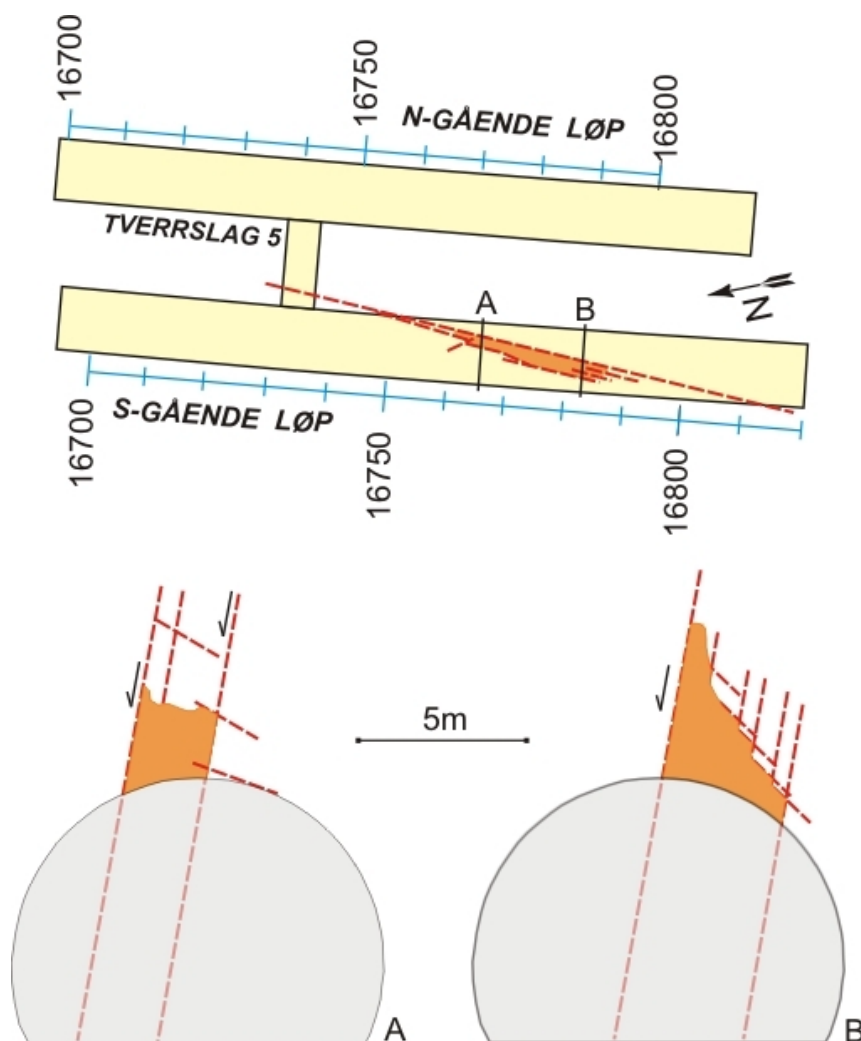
Oversiktsbilde som viser utstrekning av det nedraste partiet i tunneltaket.
